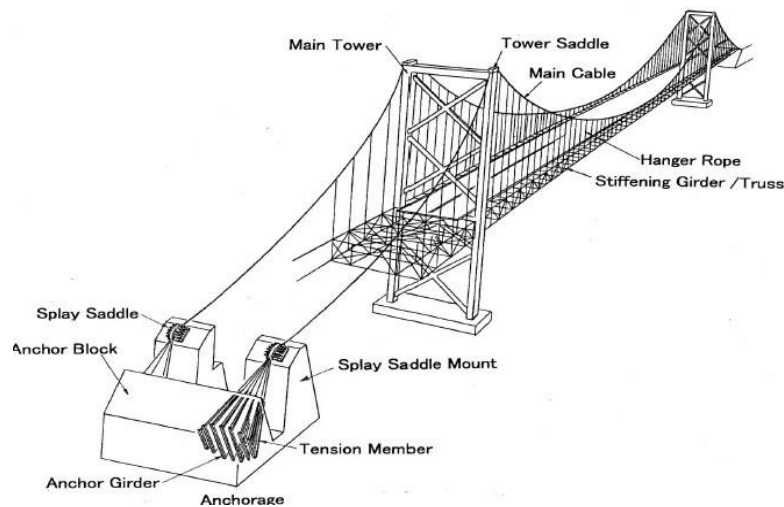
Vista del puente con los cables principales, Tirantes, Torre, Armadura de Refuerzo, Anclaje.
